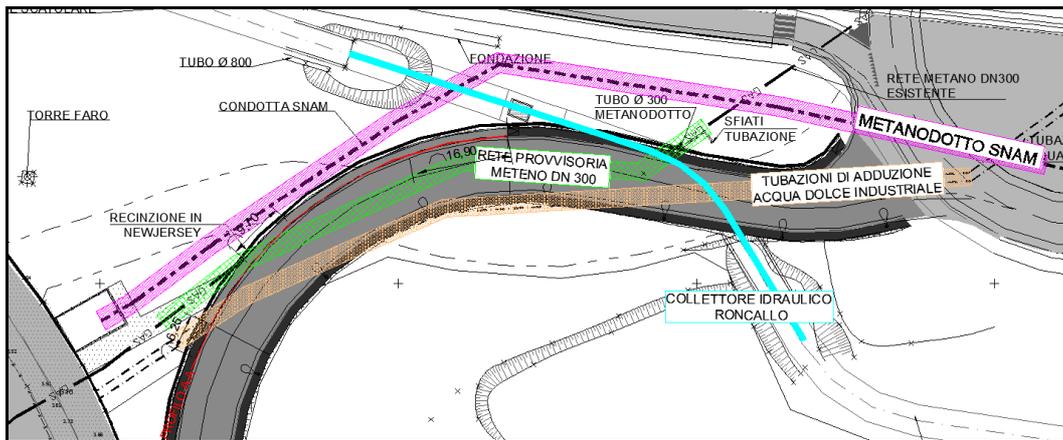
Traccia delle tubazioni intercettate planimetricamente dal tracciato in progetto.
